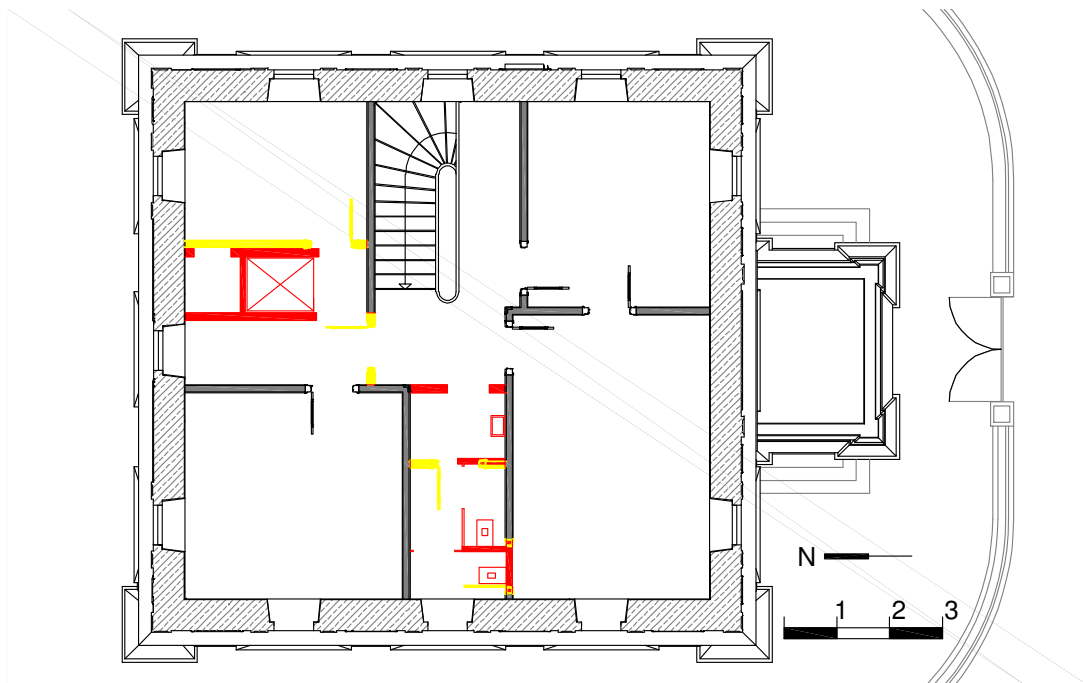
Planta do Piso 3 com as Cores Convencionais
